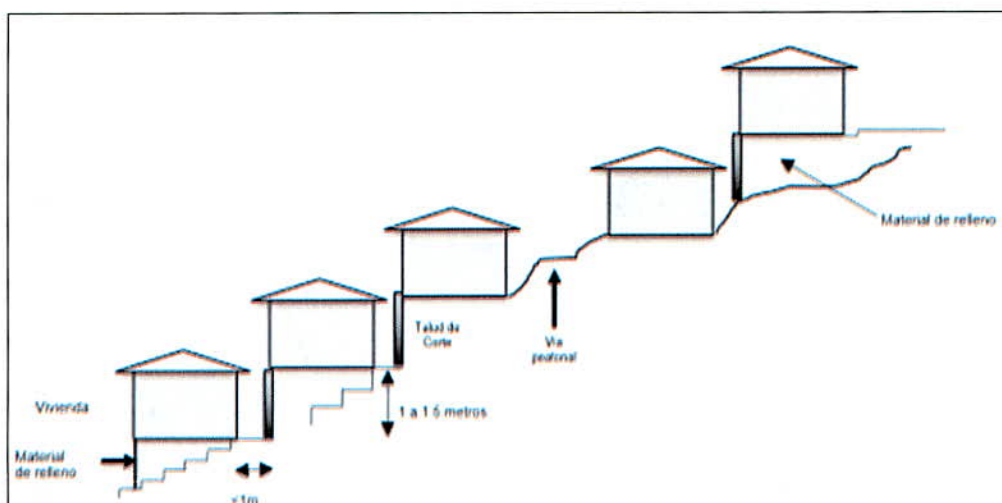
Perfil típico de emplazamiento de las viviendas en el polígono evaluado
